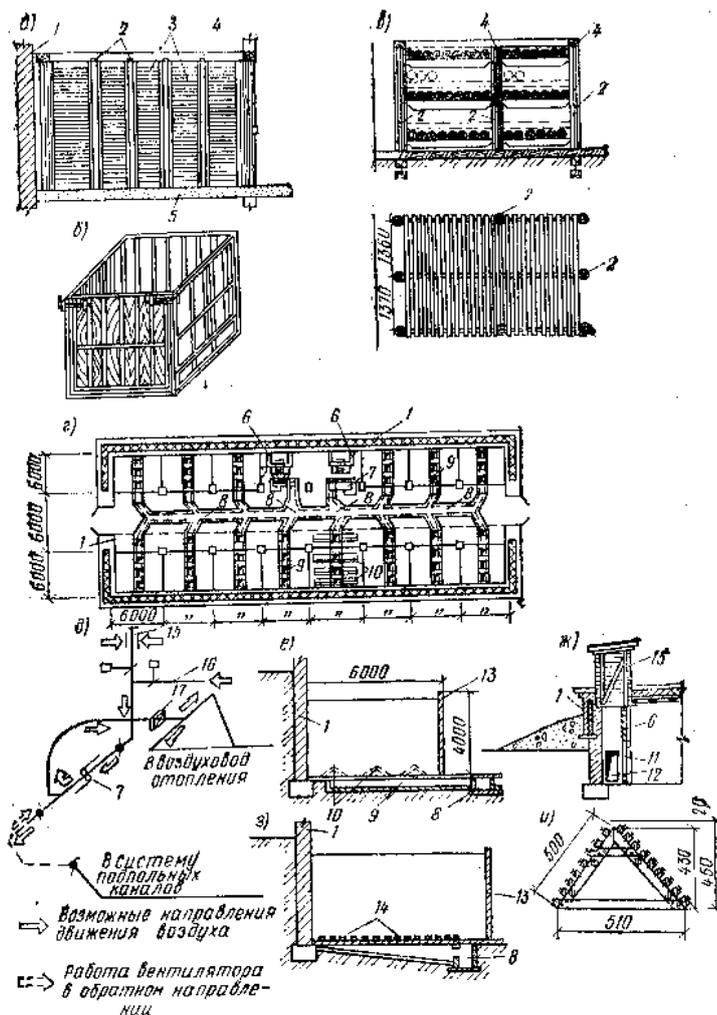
Оборудование картофеле- и овощехранилищ
